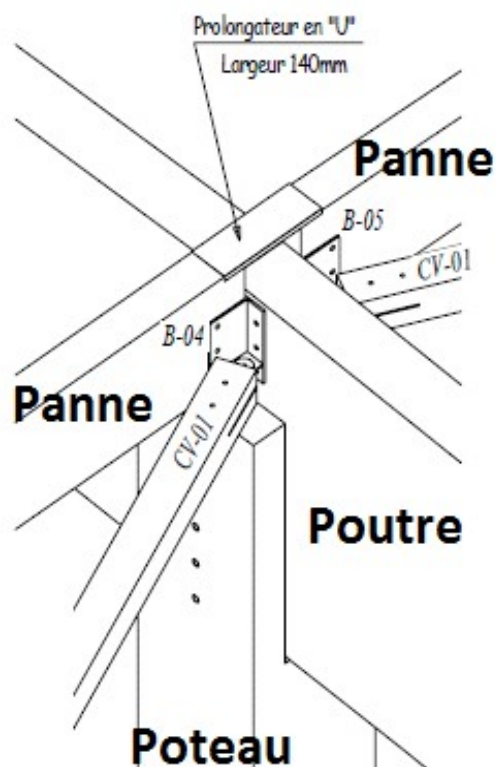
Vue en perspective de la liaison panne/poutre/poteau
